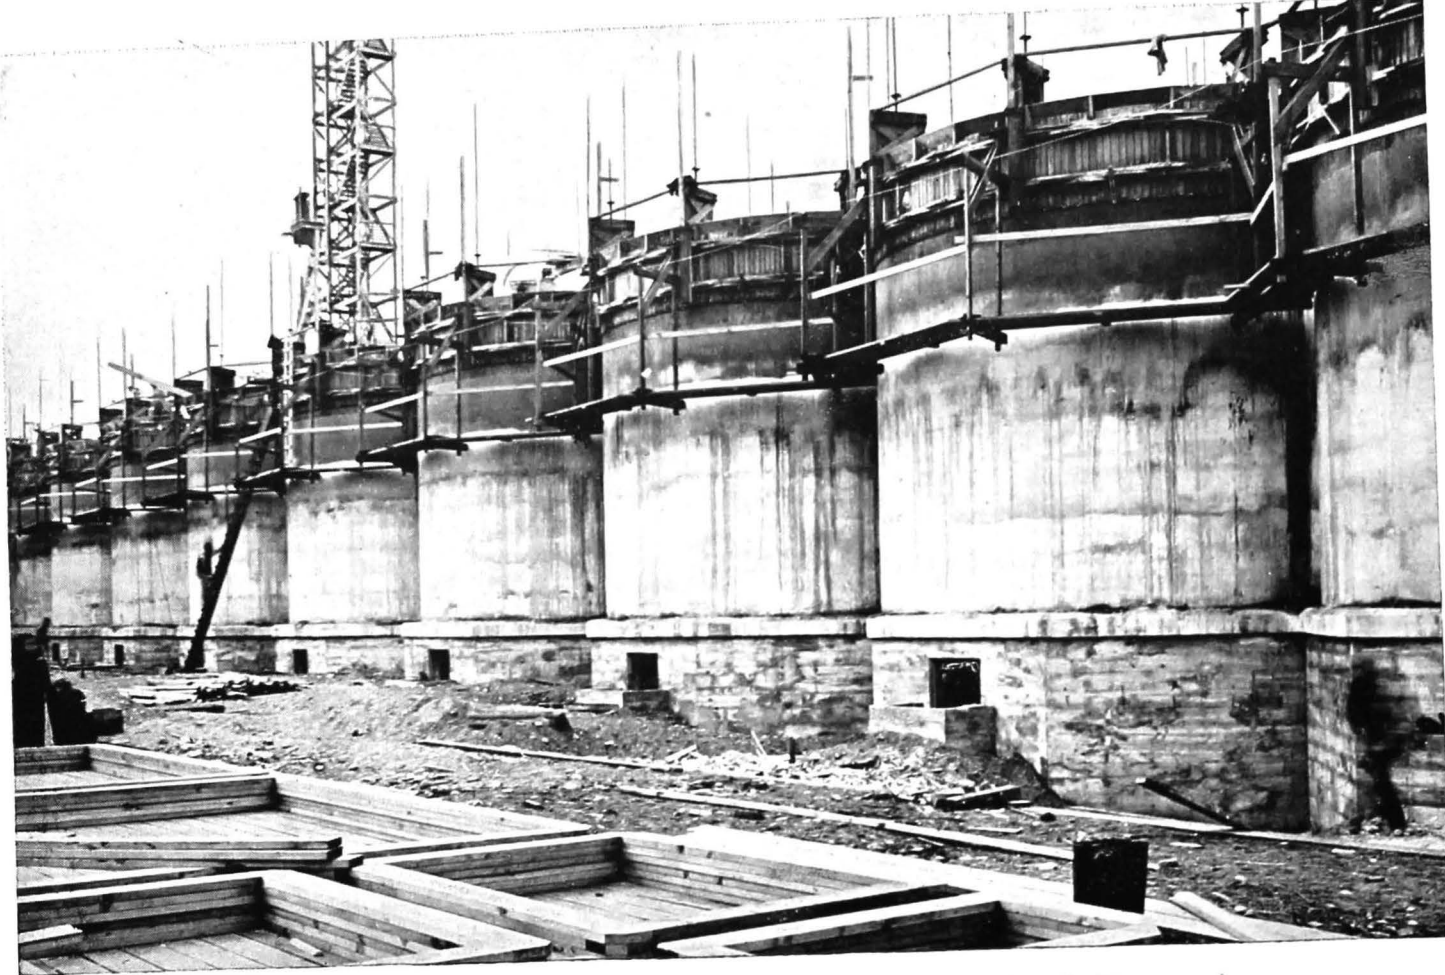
Şantierul elevatorului Burrard din Victoria (Insula Vancouver)
